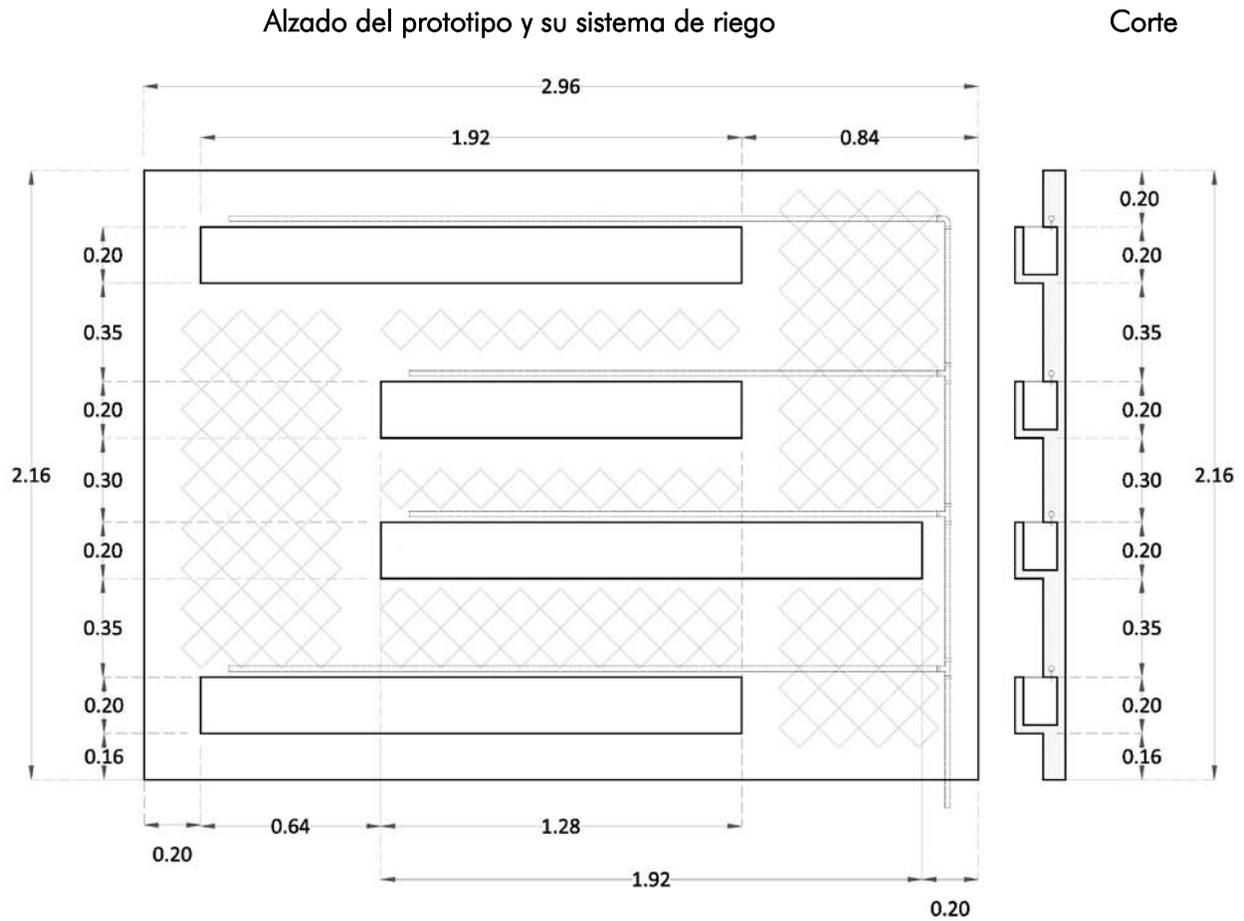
Alzado y corte de propuesta de panel prefabricado para fachadas vegetales.
